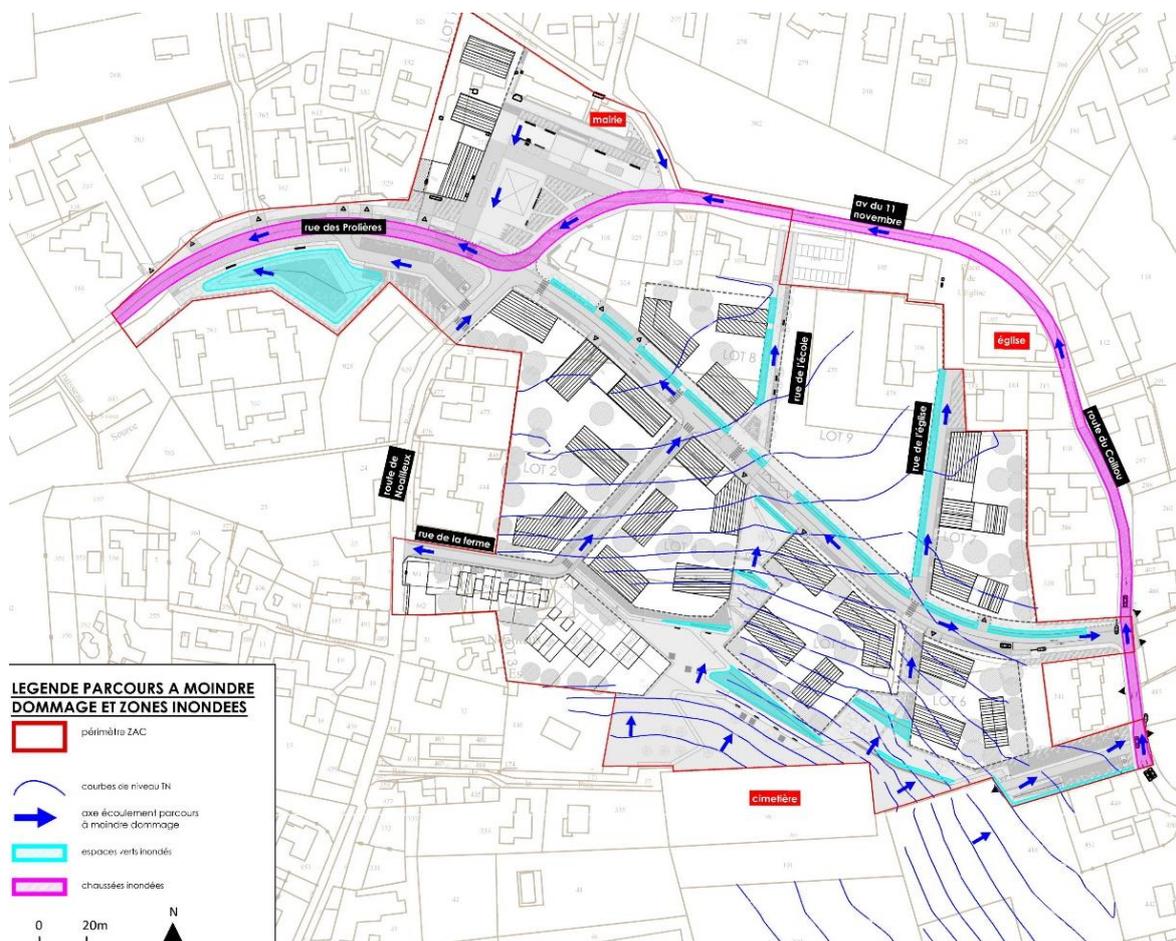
Plan des zones inondées pour les pluies exceptionnelles, SOTREC, avril 2023
